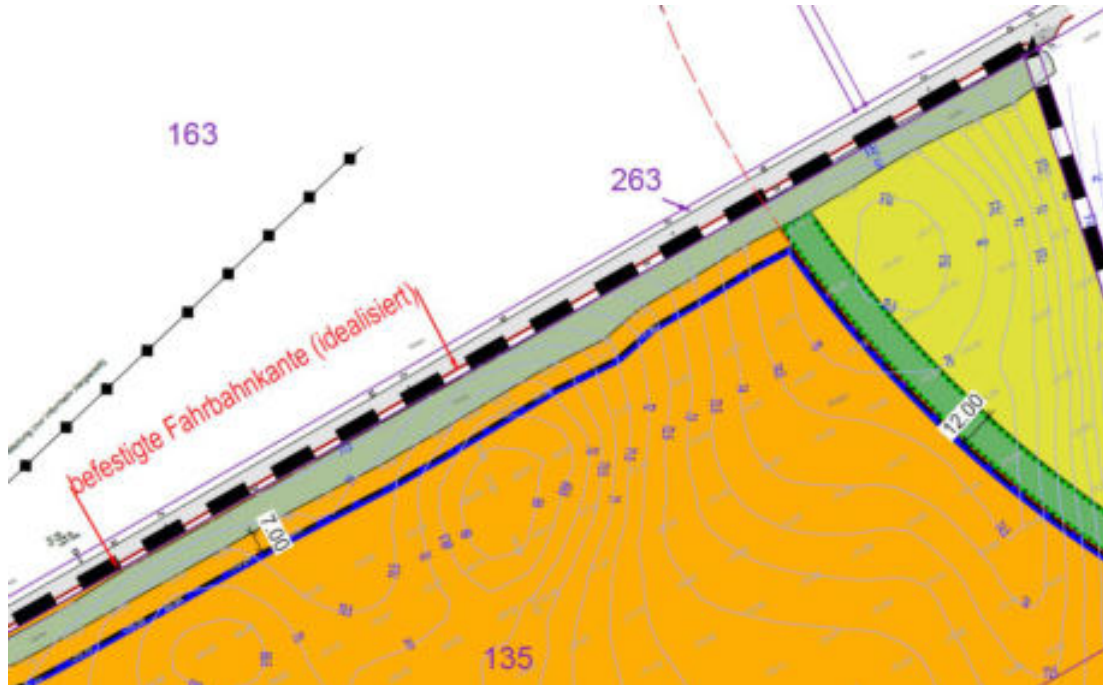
Ausschnitt aus der Planzeichnung; Darstellung Gehölzstruktur im Norden des Plangebiets
